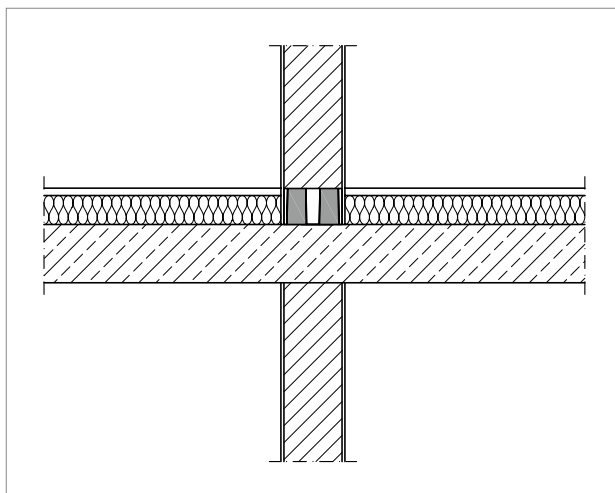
Darstellung einer Schnittzeichnung mit detailliertem Schöck Sconnex® Modell
